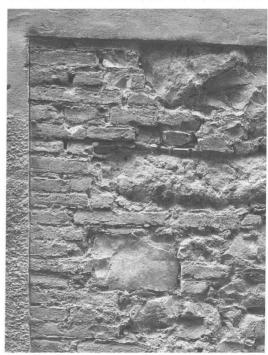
Aparejos de mampostería particular (foto del autor 2013)
